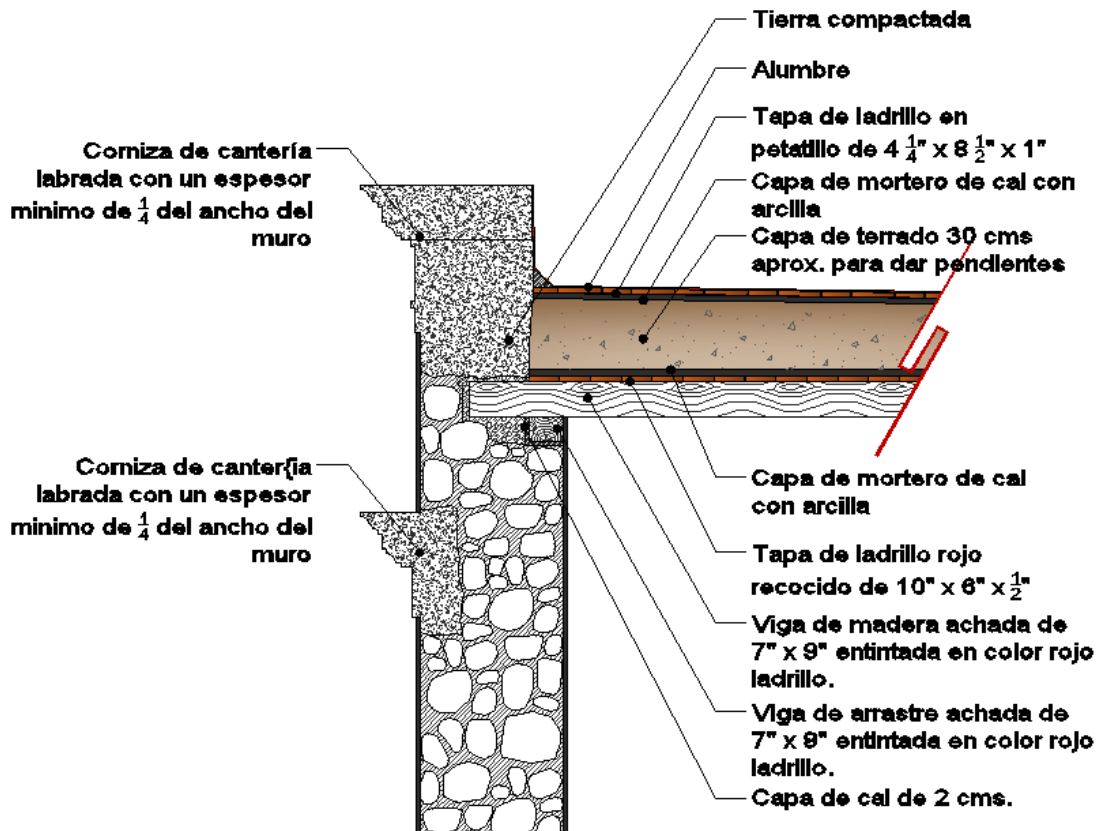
Corte por fachada de cubiertas. Elaboró: Alelí Cortes
